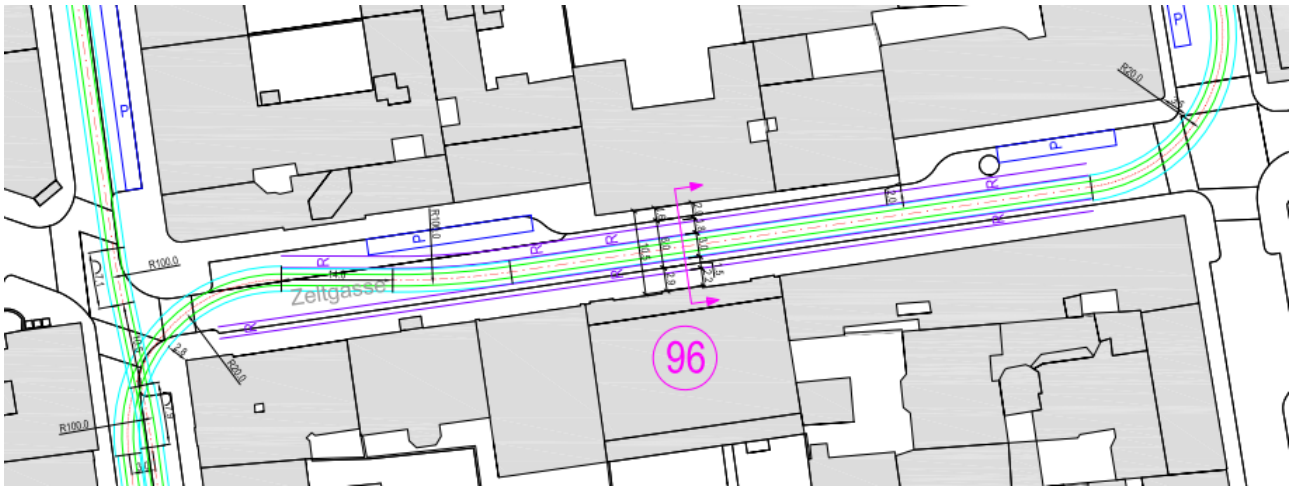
Lageplan Zeltgasse 2. Entwurf
